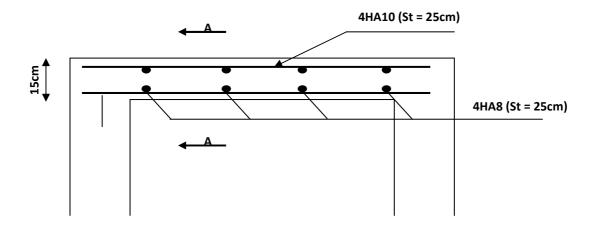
Plan de ferraillage de la dalle de la salle machine
